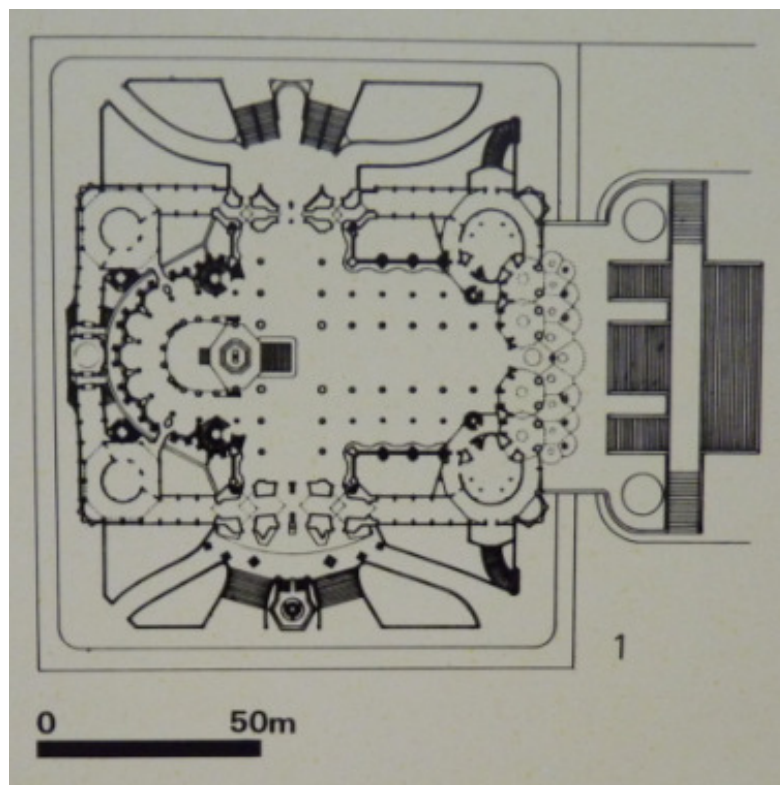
, Anton Gaudí, Sagrada Familia, Barcelona, Grundriss, ab 1882.
